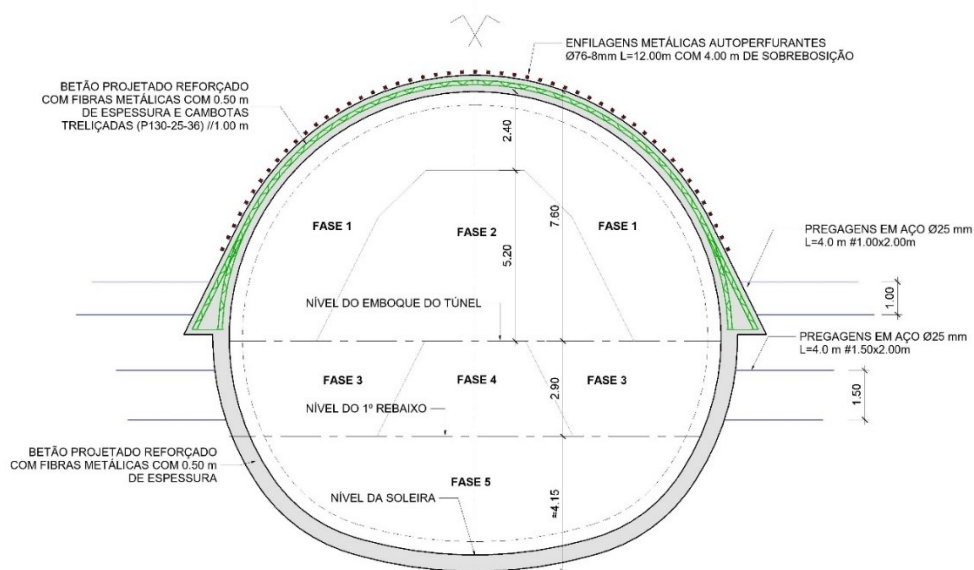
Corte transversal da secção 2 do túnel de ligação.
